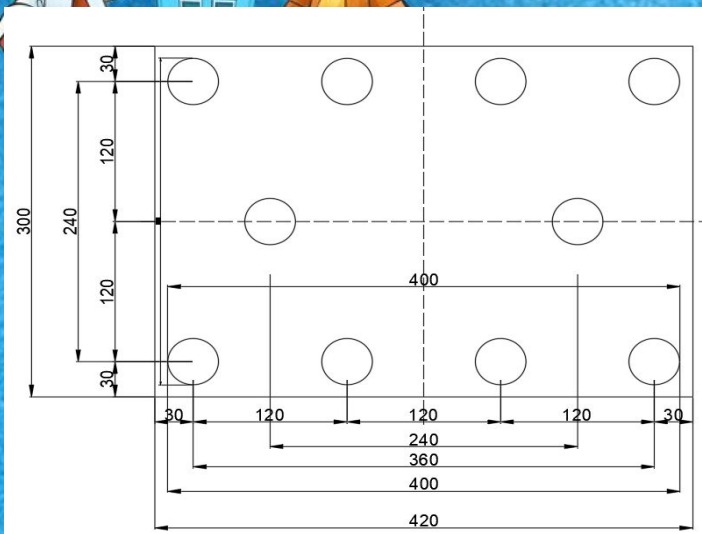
Расчётная схема к расчёту осадки фундамента
